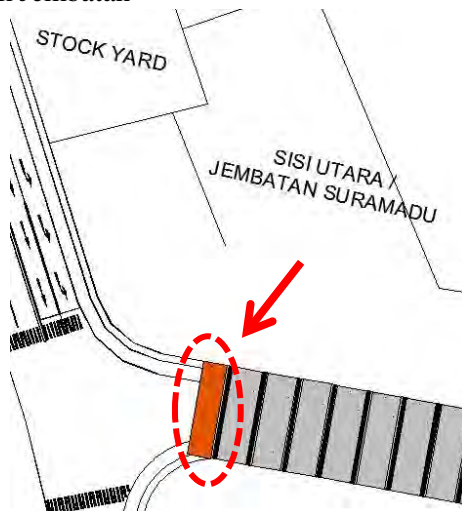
Tampak samping Ereksi precast slab on pile
